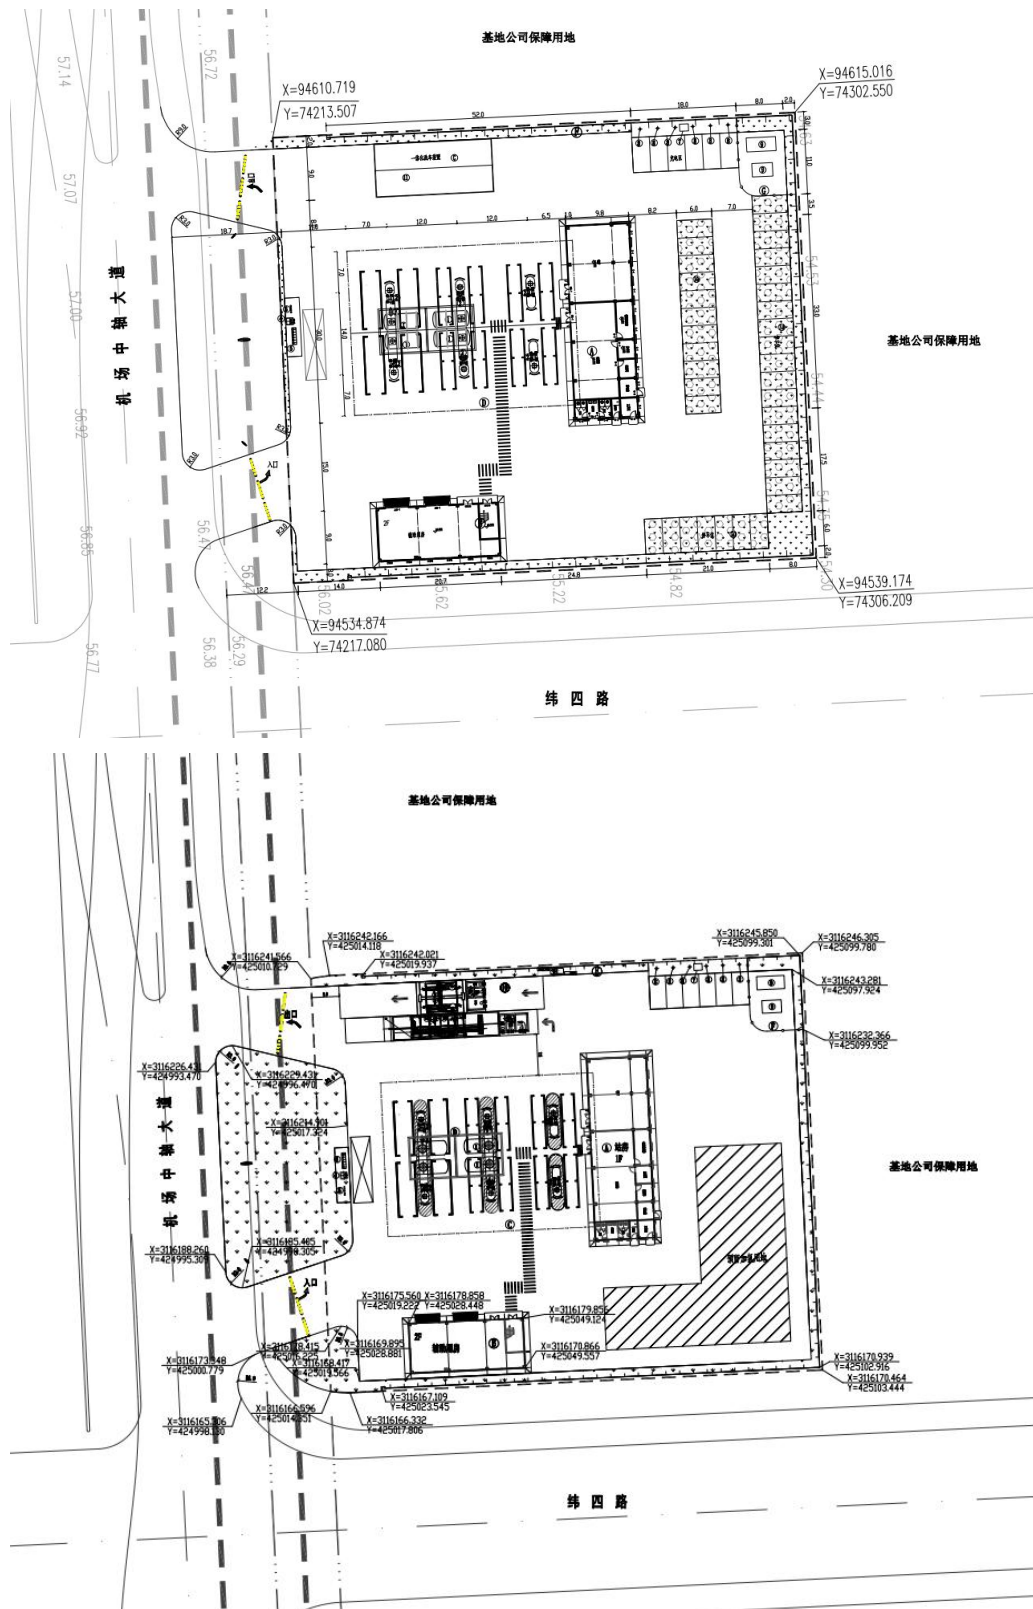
航站区进场加油站总平面布置图（含预留加氢站位置）
